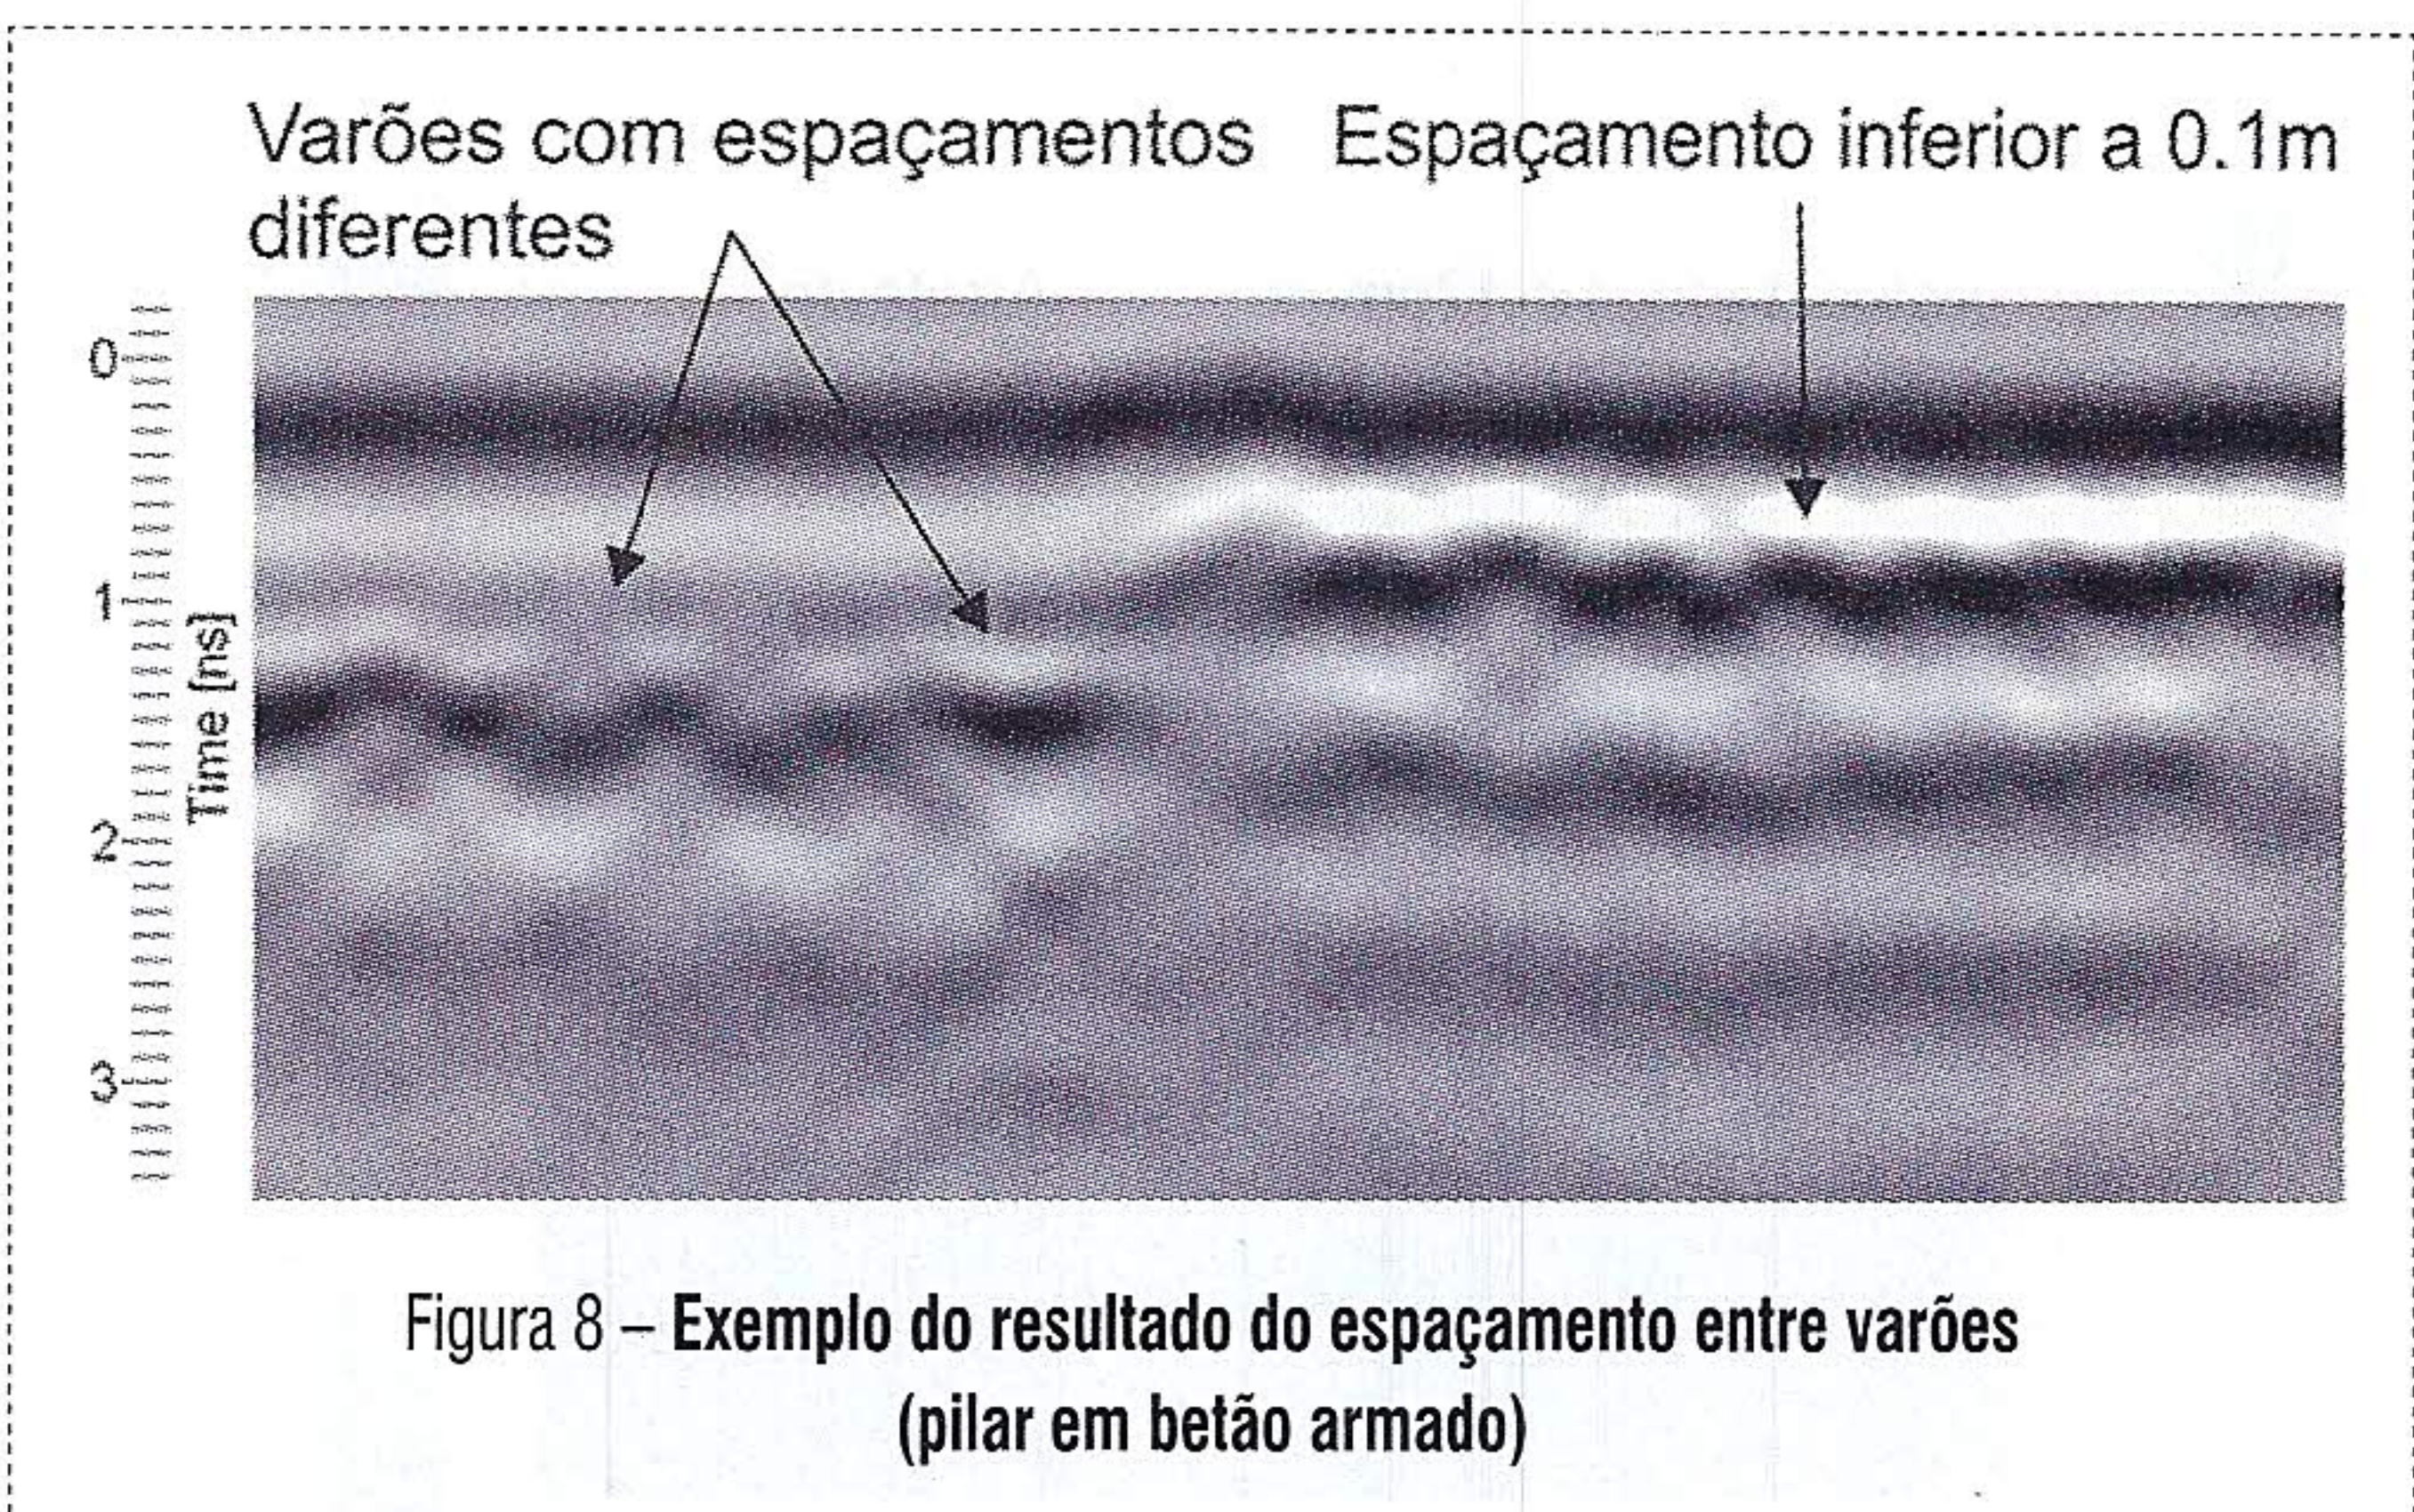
Exemplo do resultado do espaçamento entre varões (pilar em betão armado)
